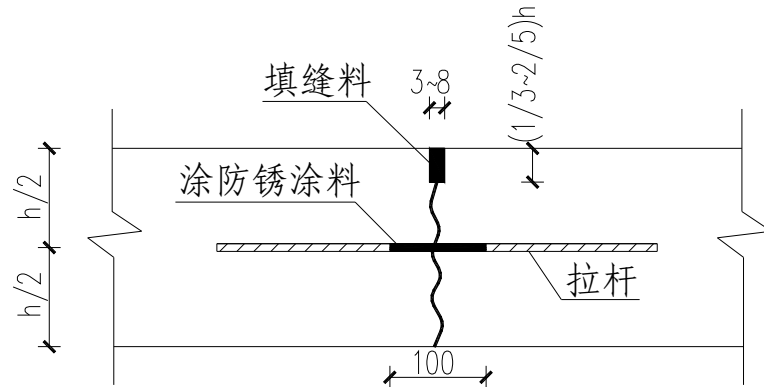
纵向缩缝构造 (尺寸单位: mm)
